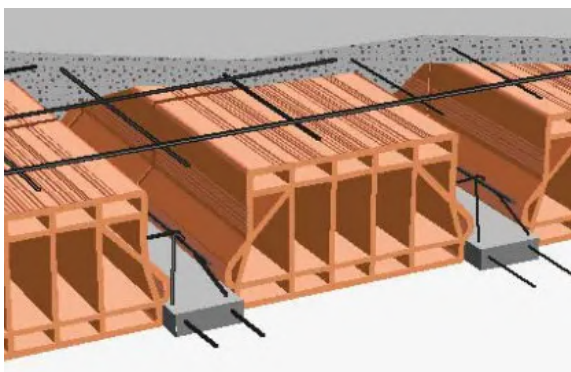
Solaio con travetti prefabbricati tralicciati
